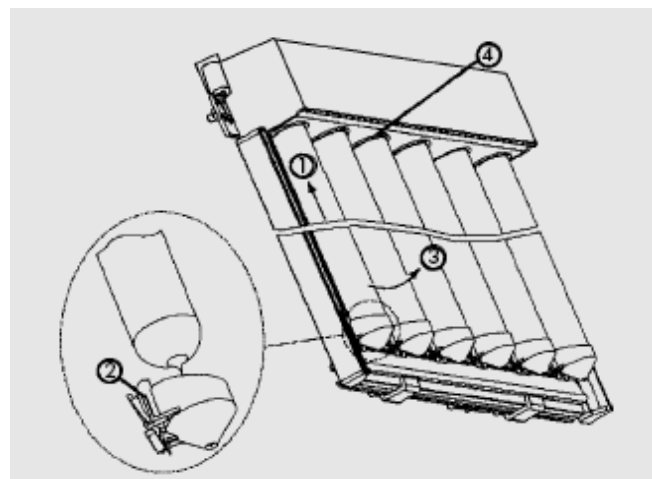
Монтаж/демонтаж отдельных трубок
